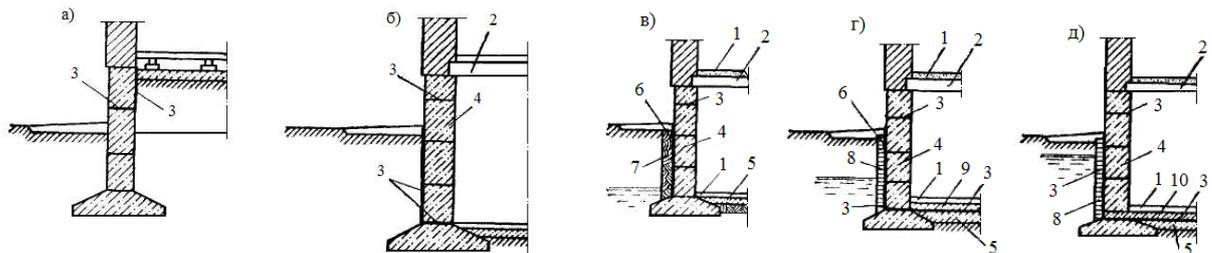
Гидроизоляция фундаментов и стен подвала здания: а – здание без подвала; б – здание с подвалом; в – здание с подвалом при напоре грунтовых вод до 0,2 м; г – то же, до 0,8 м; д – то же, более 0,8 м;
